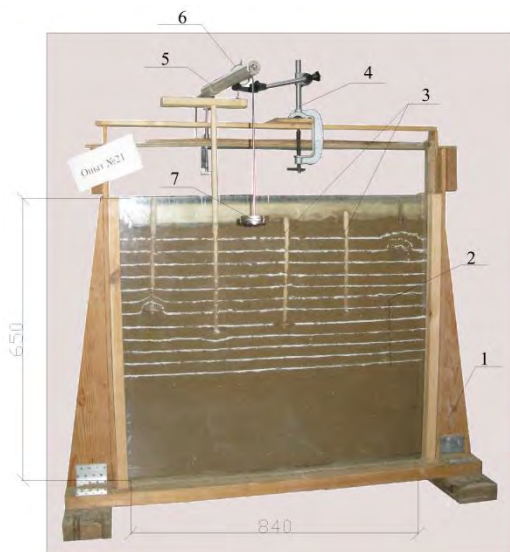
Общий вид плоского лотка, и модельных свай в процессе их испытаний: 1 – деревянный лоток; 2 – контрольные меловые полоски для оценки деформации грунта; 3 – модель винтовой сваи; 4 – трубочина для крепления индикатора; 5 – рычажное устройство для нагружения модели свай; 6 – индикатор часового типа; 7 – площадка для грузов массой 100, 200 и 500 г
